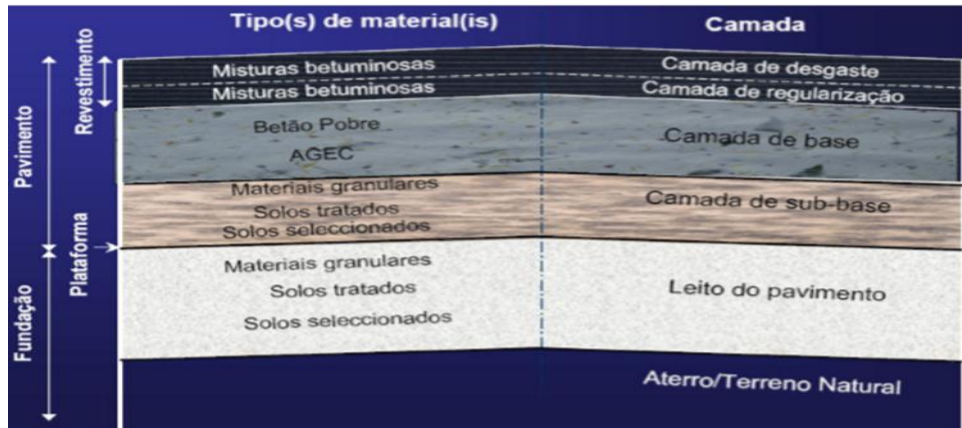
Estrutura de um pavimento semi-rígido. (REIS, 2009).
